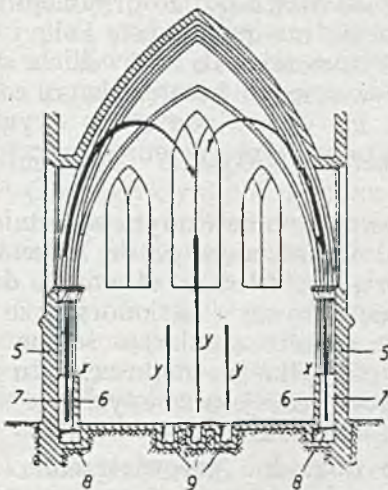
i 20 przedstawiają schematy nowego systemu ogrzewania. Rys. 19 przedstawia przekrój przez nawę, w której powietrze wciągane jest tuż przy ziemi, zaś rys. 20 przekrój
